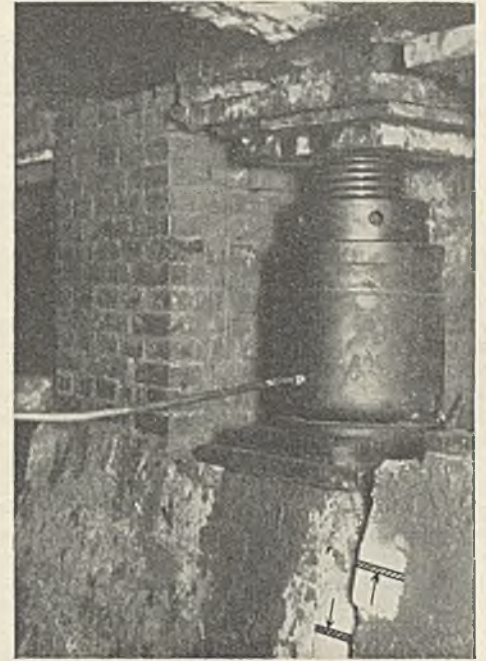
Nach dem Abpressen eines Betondruckkörpers.
